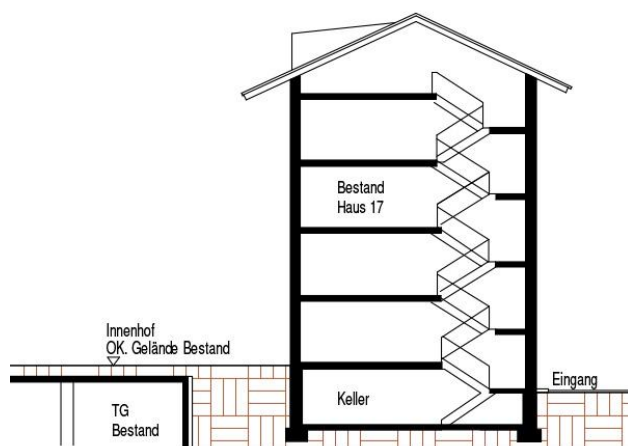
Schnitt Skizze Höhenbezugspunkt OK. Gelände Bestand Innenhof für WA, WR_1
